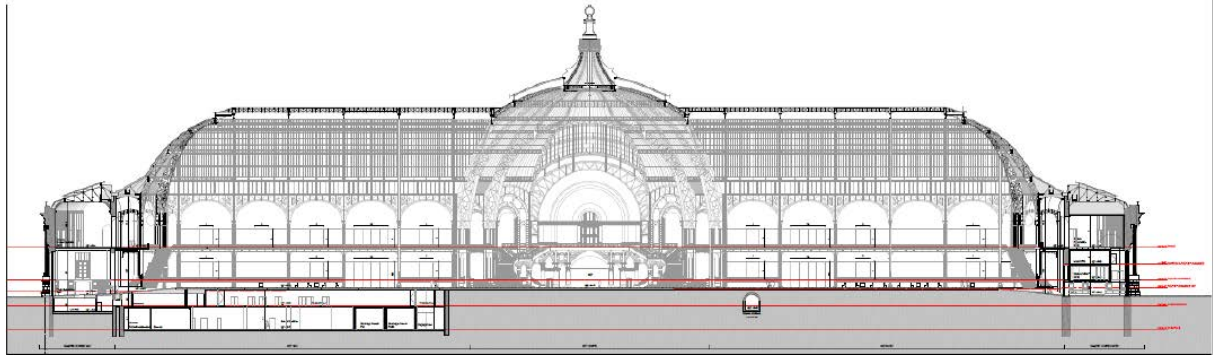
Plan de coupe : zone logistique située en sous-sol au Sud de la Nef © LAN
